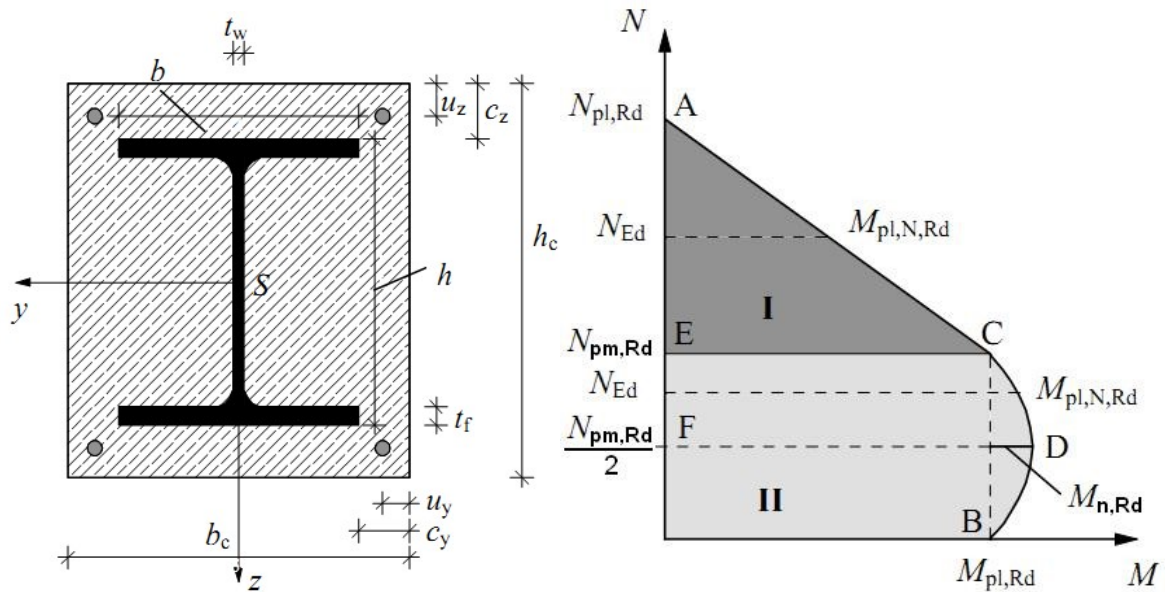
Переріз сталезалізобетонної колони у вигляді повністю обетонованого сталевих двотавра (ліворуч); наближення для кривої взаємодії між згинальним моментом і поздовжньою силою (праворуч)
